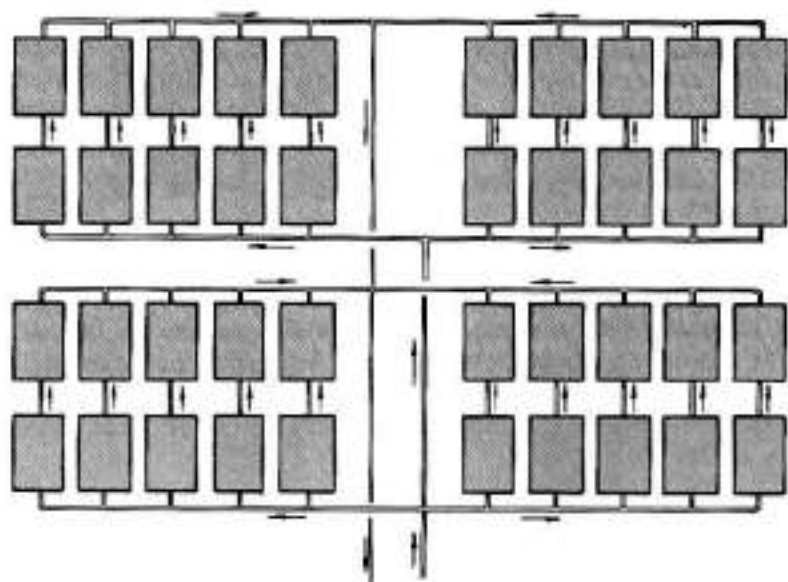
Conexión de paneles solares mixta serie-paralelo.
